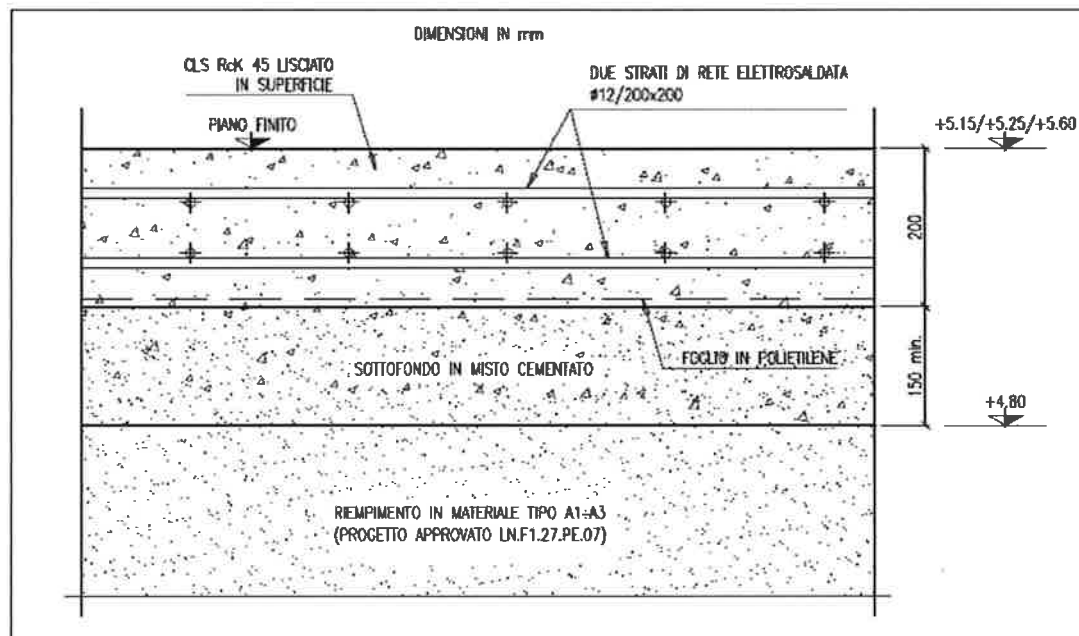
DETTAGLIO PAVIMENTAZIONE IN C.A. PIAZZALE IMPIANTI
